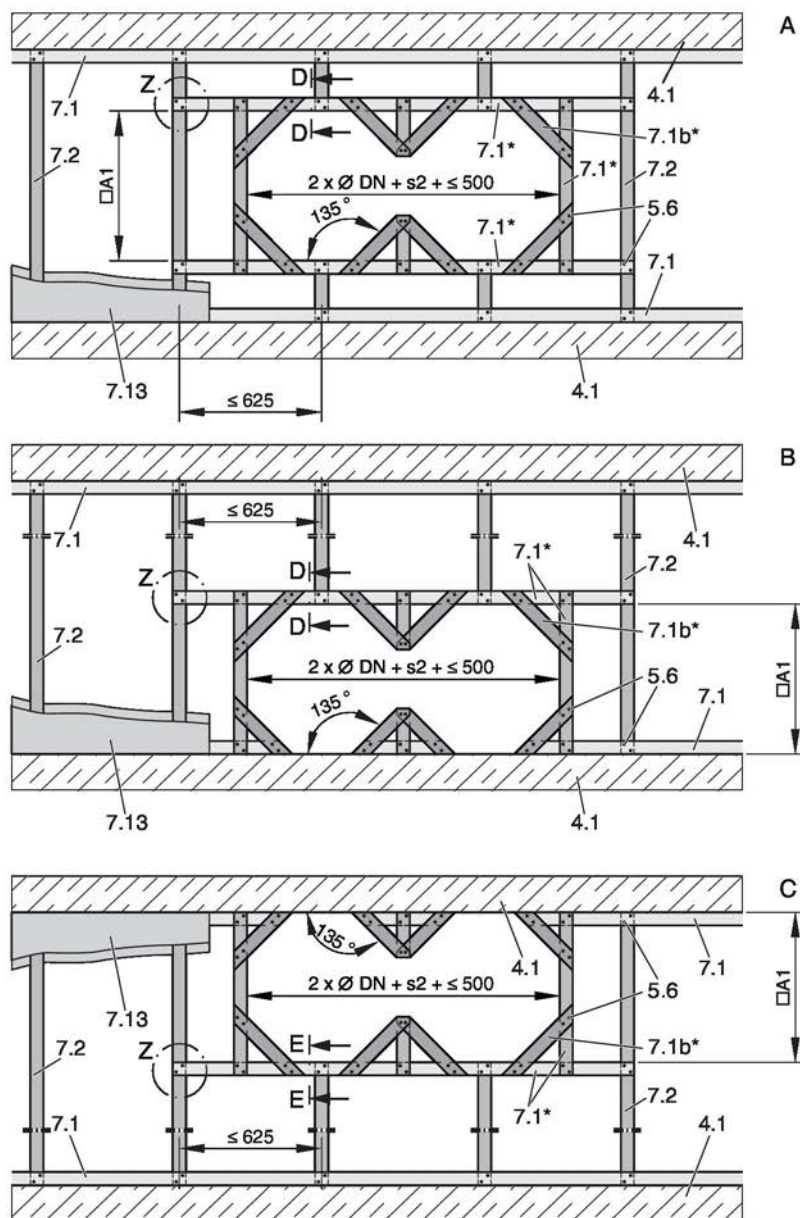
Perete despărțitor ușor cu structură metalică de susținere și placare pe ambele părți, flanșă la flanșă, \varnothing lățimea nominală 450 – 800, legendă ↪ Fig. 33
